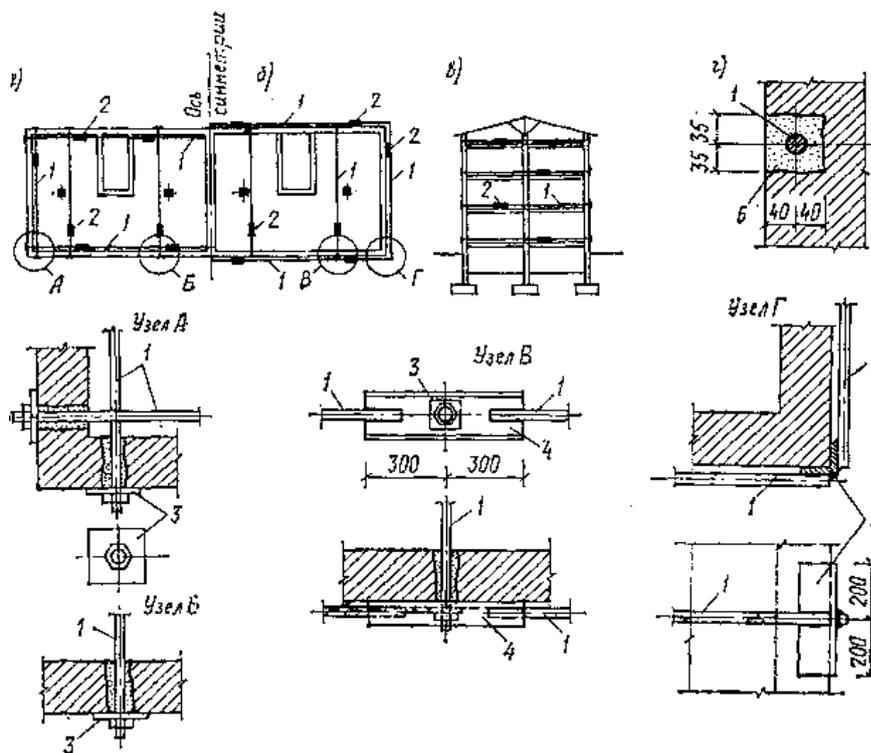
Крепление стен металлическими тяжами в уровне перекрытий
